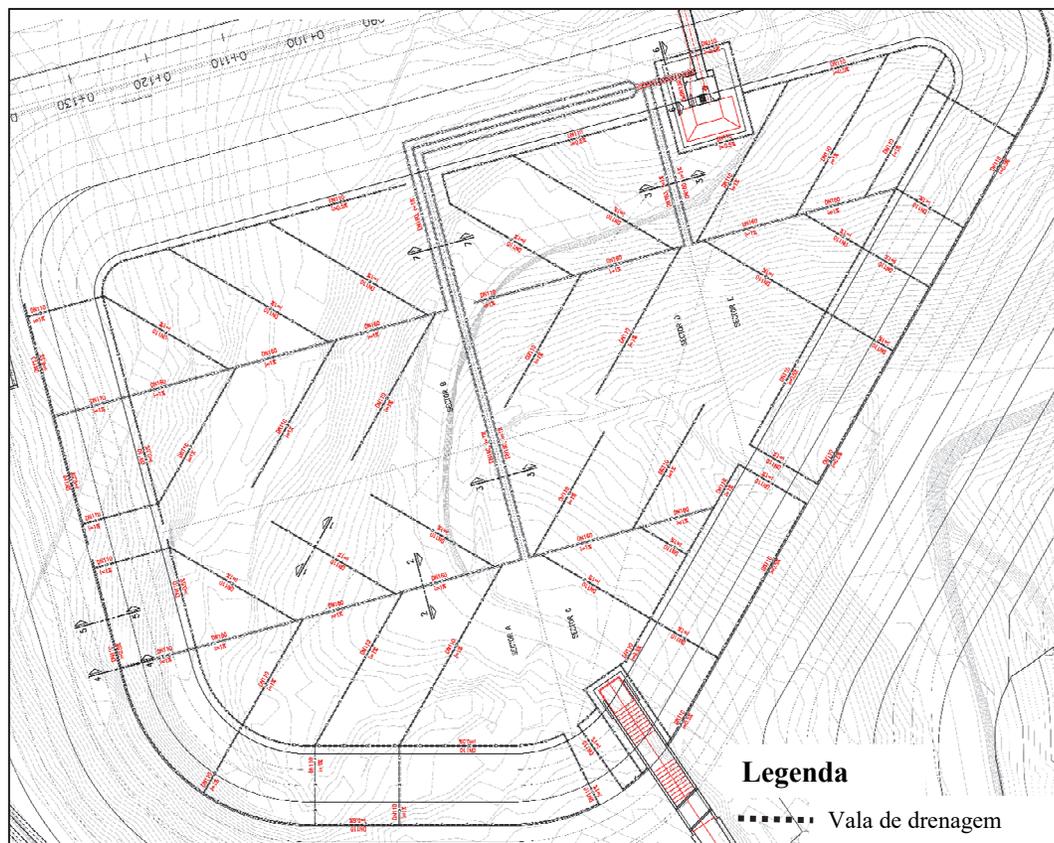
Planta com o sistema de drenagem subsuperficial da BP.
